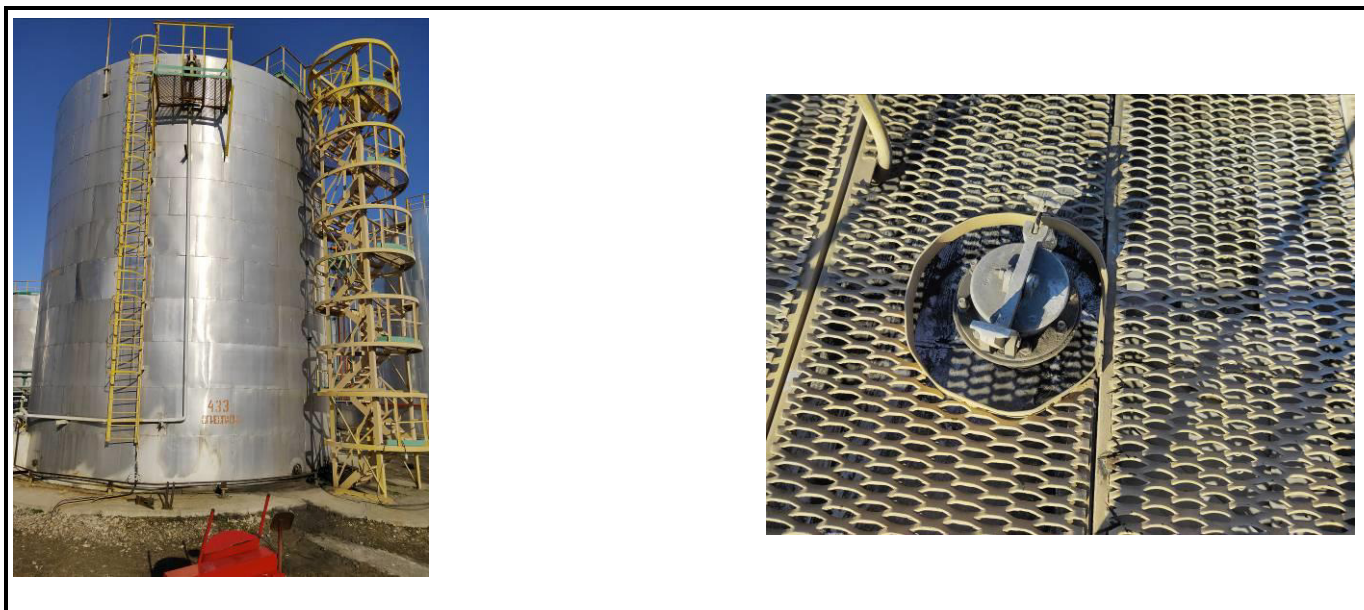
Общий вид резервуара РВС-1000 (№433) с замерным люком
